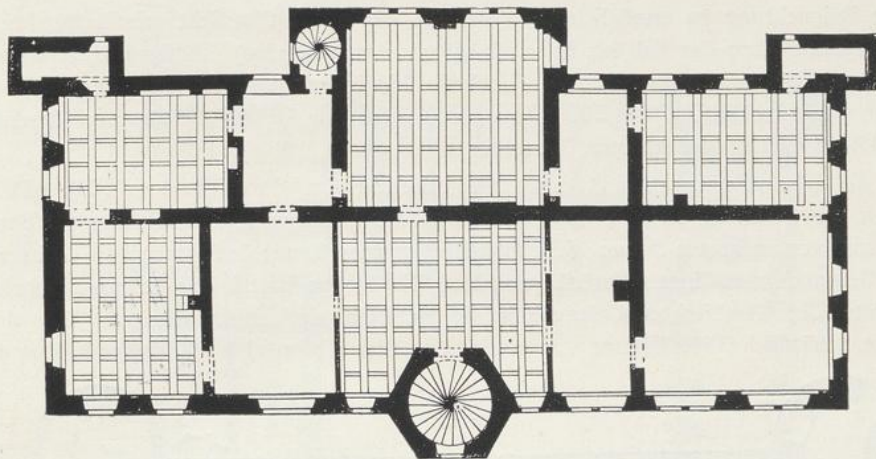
Schloß Schönfeld. Erdgeschoß.
